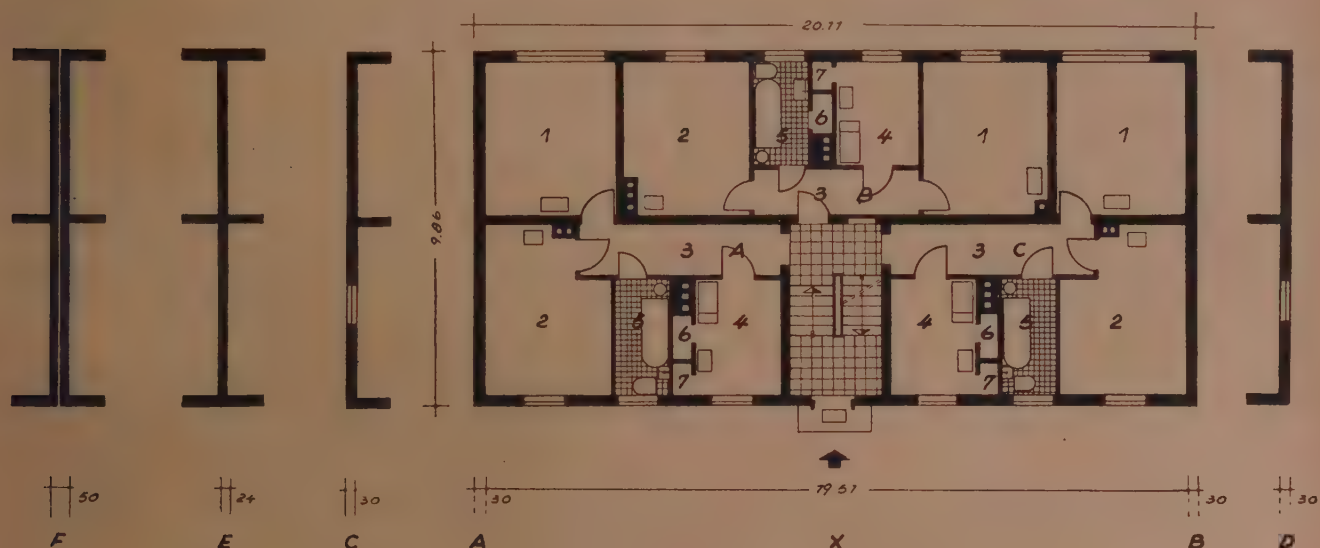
Sektion W 56/4 Leipzig - Wohngeschoßgrundriß
